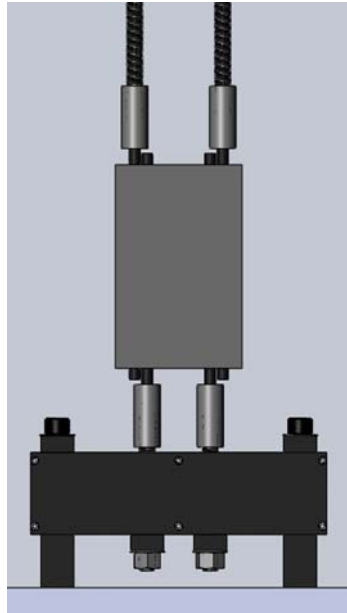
Stabilité du spécimen assuré par les coupleurs inférieurs reposant sur les poutres de transfert
